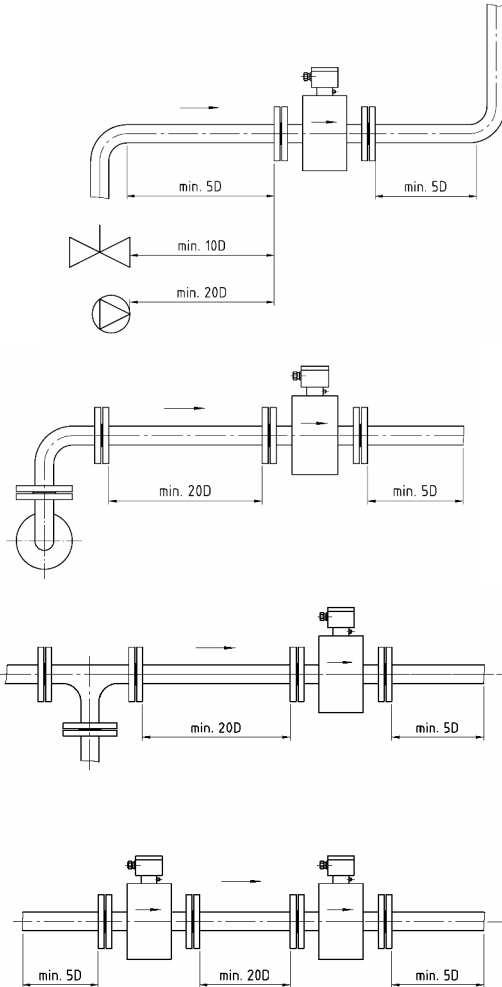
Einbau zwischen Rohrkrümmern, Ventilen und Pumpen
